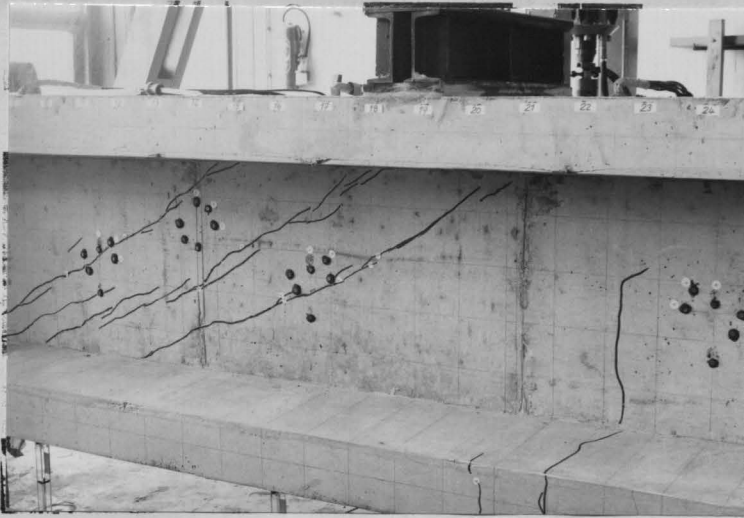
Rißbild Balken B4, 1. Laststellung
